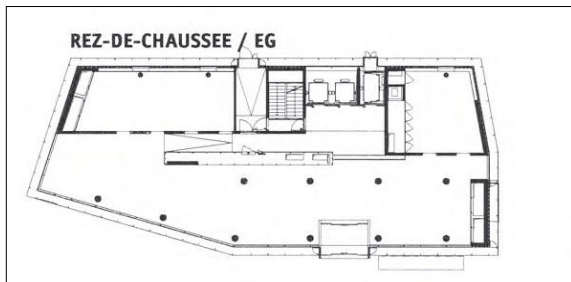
Plans Rez de Chaussée de la Tour<sup>32</sup>.
